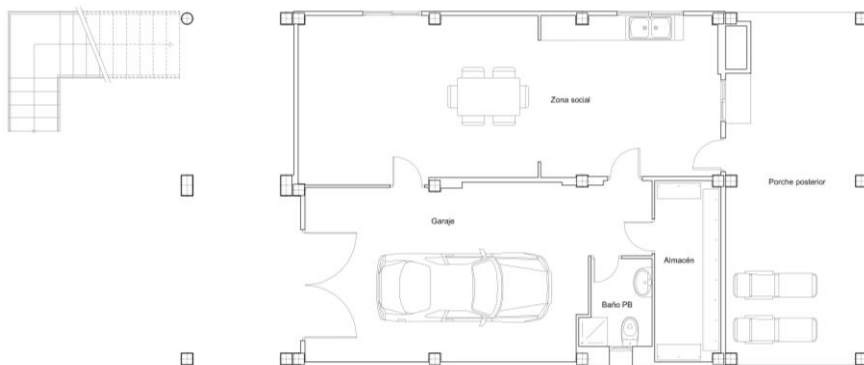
Distribución Planta baja. 2024. Fuente: Propia
